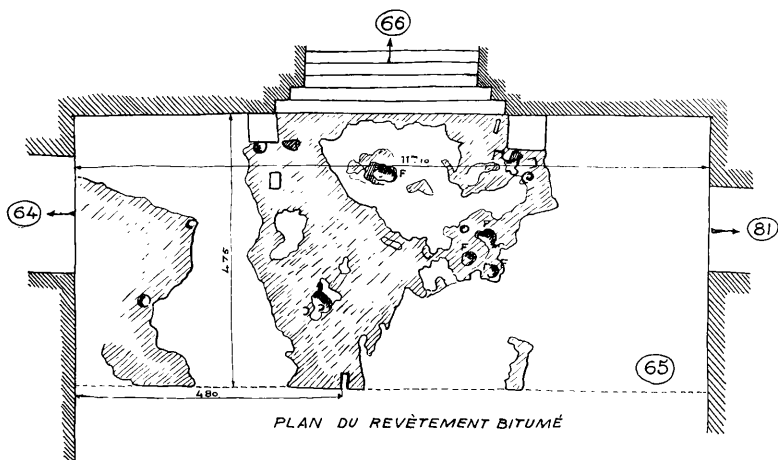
Salle 65. Revêtement bitumé au pied de l'escalier de la tribune 66.
